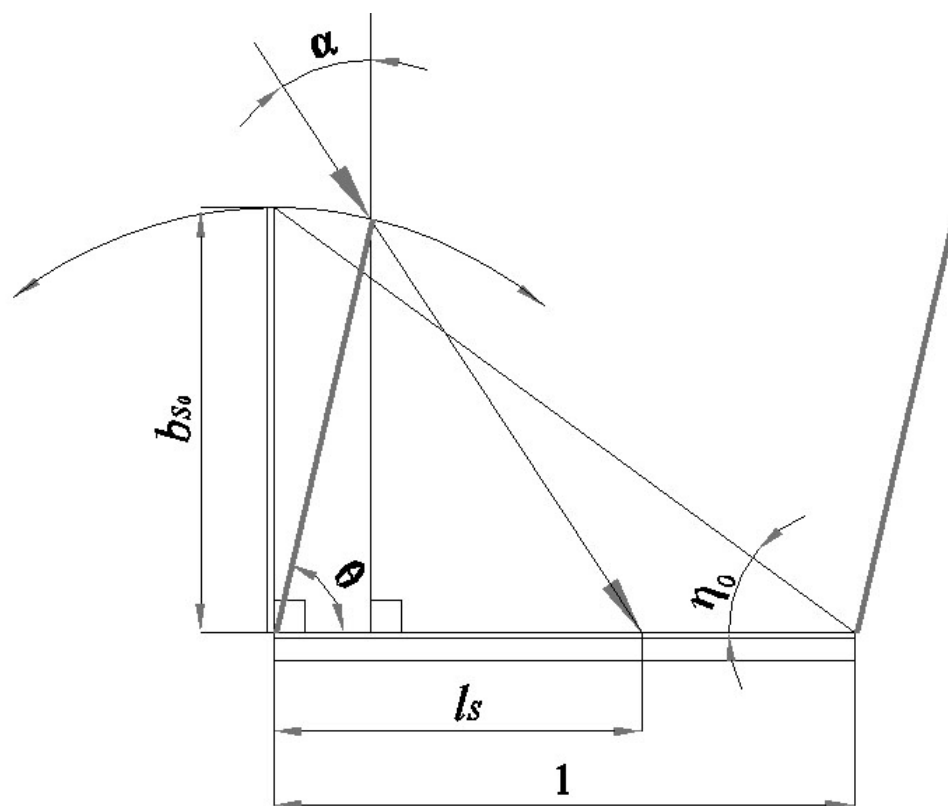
Затінення геометричними СЗП із поворотними щитами
